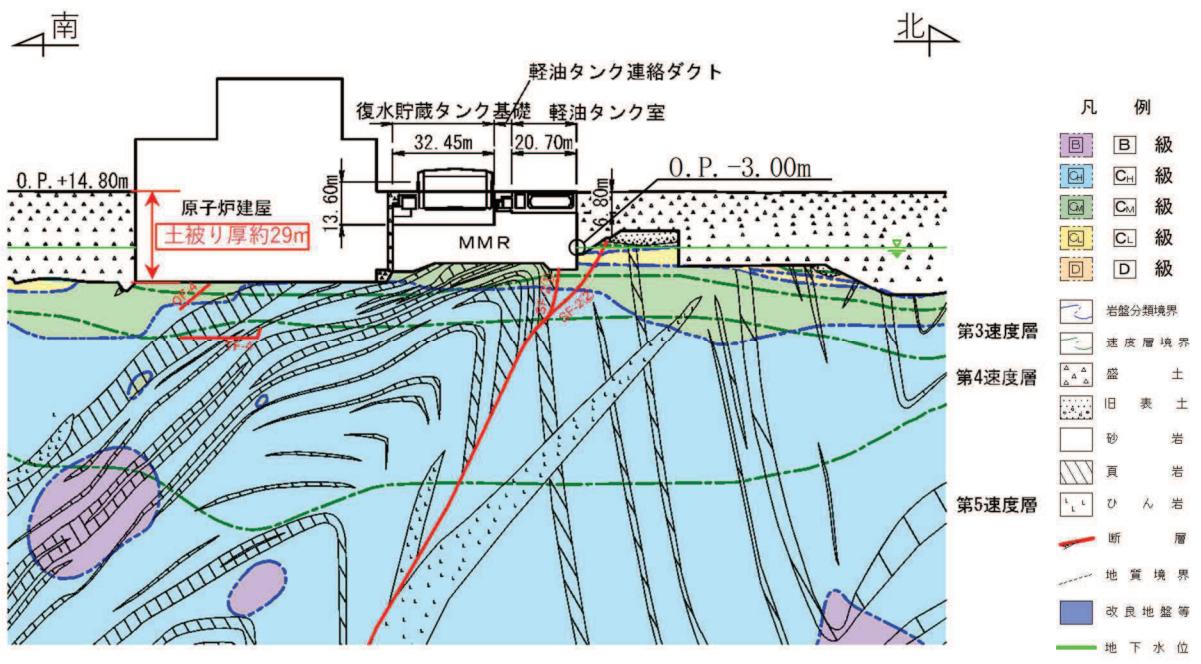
復水貯蔵タンク基礎 地質断面図 (A-A 断面, 南北)
